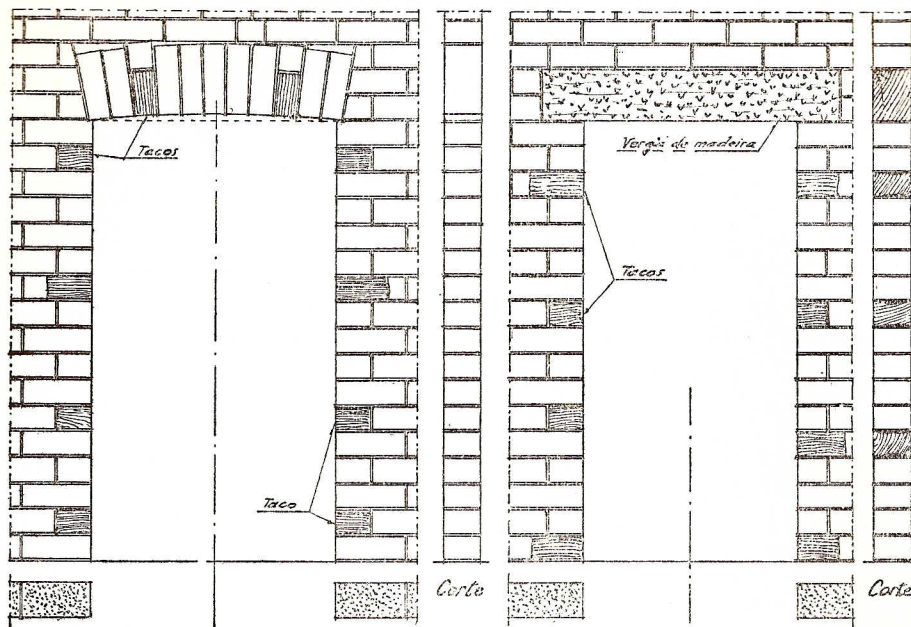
PORTAIS EM PAREDES INTERIORES DE TIJOLO
